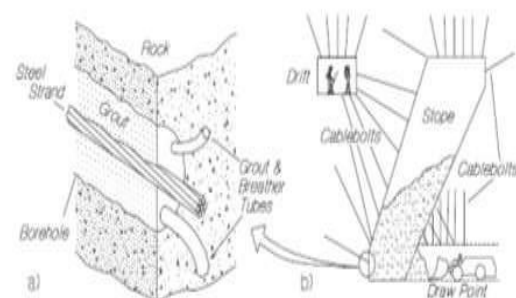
a) Elementos del cable Bolting, b) Típica malla de instalación de cable bolting.
